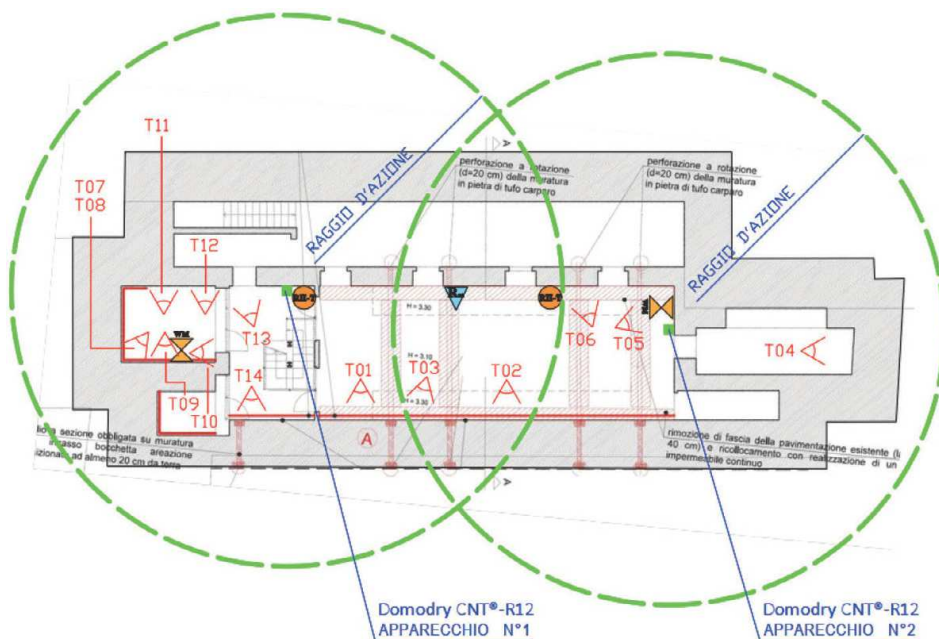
Complesso di S. Francesco alla Scarpa: schema planimetrico impianto CNT
